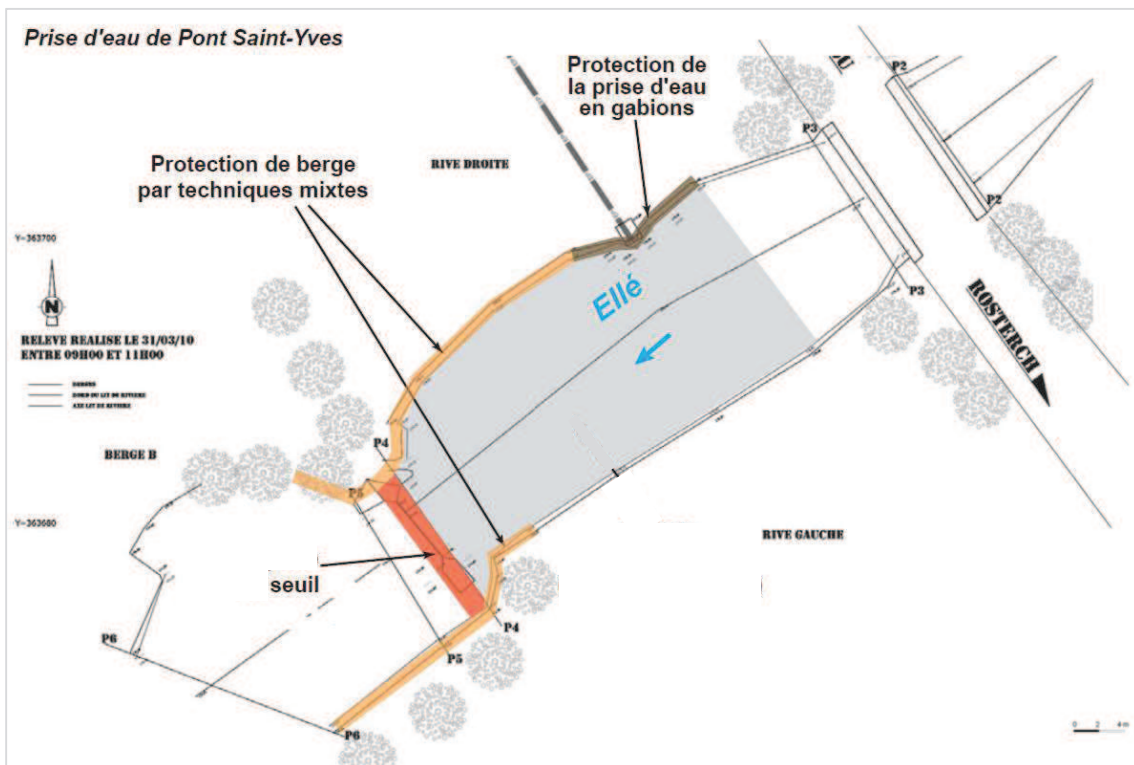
Plan d'implantation de la prise d'eau de Pont Saint Yves
